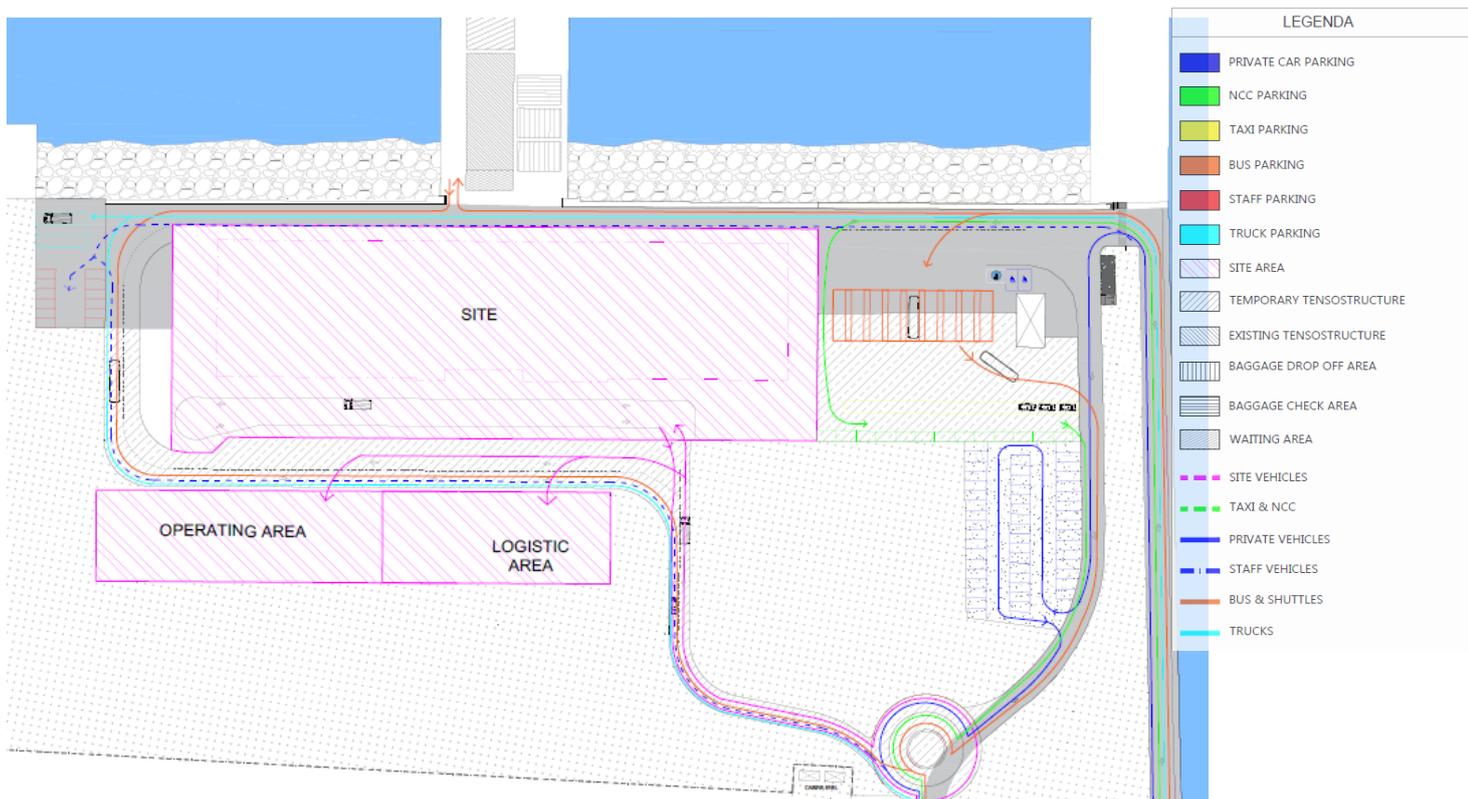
Configurazione Temporanea in fase di costruzione del Terminal- Layout
